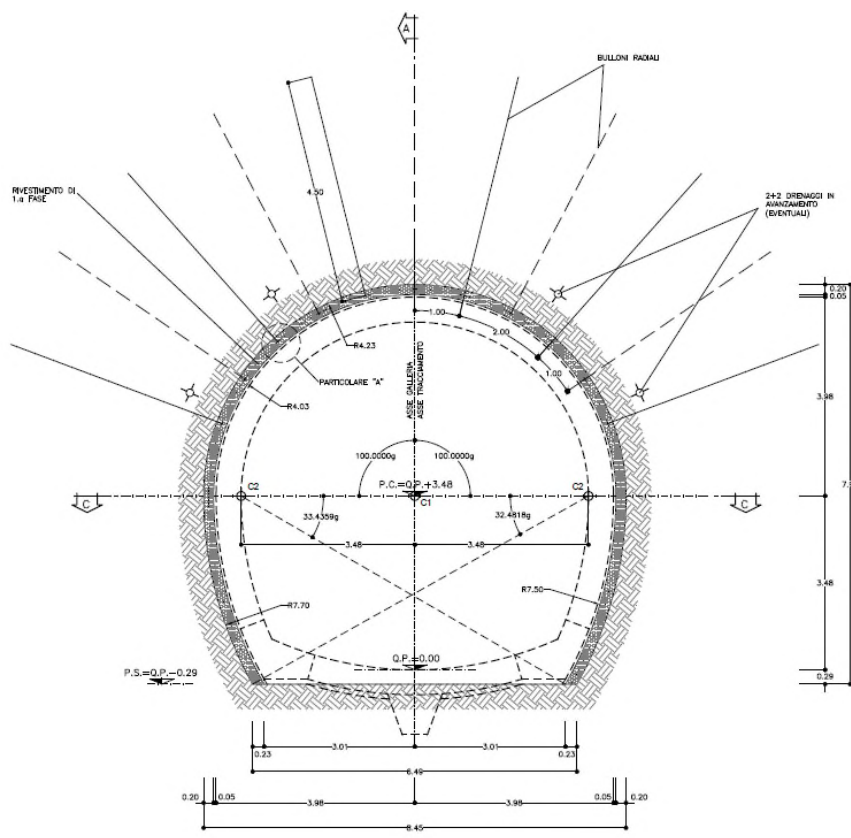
Sezione Tipo Ab – Scavi e consolidamenti - Sezione
